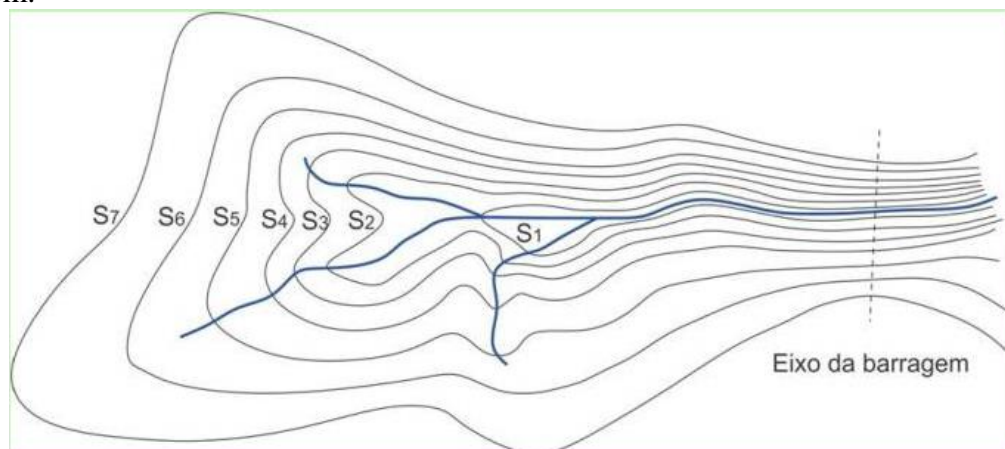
Planta Planialtimétrica do local da construção e levantamento do eixo da barragem.
